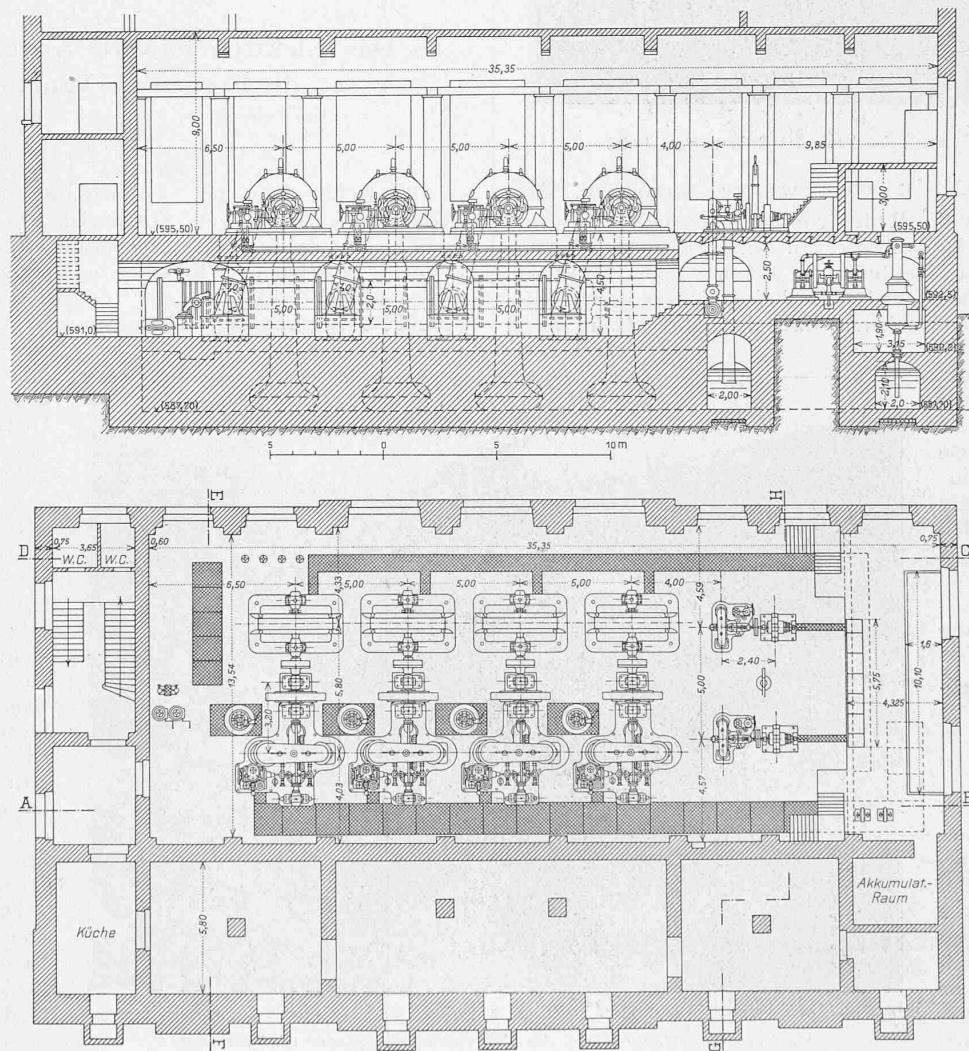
und 32. Grundriss und Schnitt A-B des Maschinenhauses. — Maßstab 1:300.
